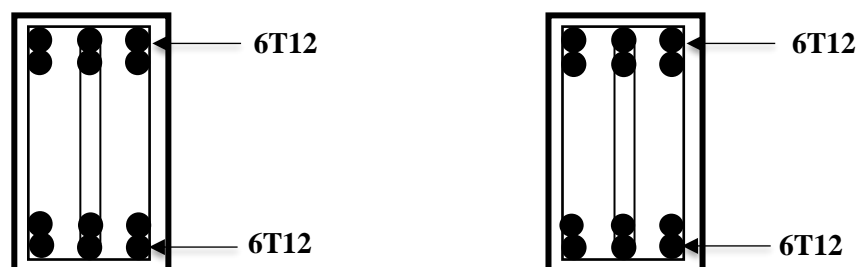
Dessin de ferrailage des sections des poutres Secondaires
